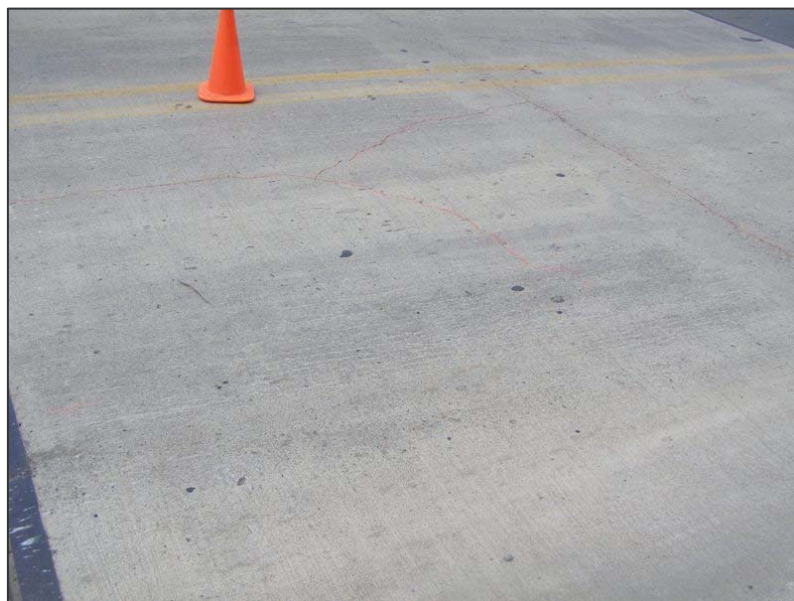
Agrietamiento en la losa de aproximación (hacia Parrita)
